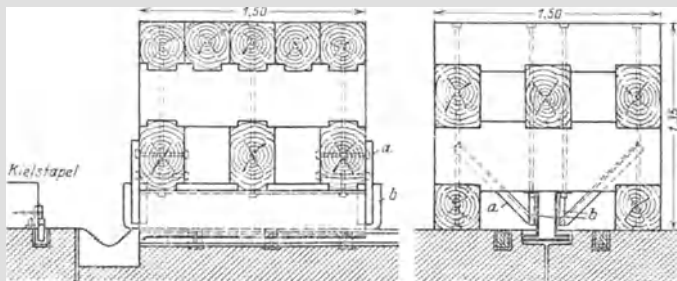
a u. b. Kimm Schlitten. Maßstab 1 : 50.
